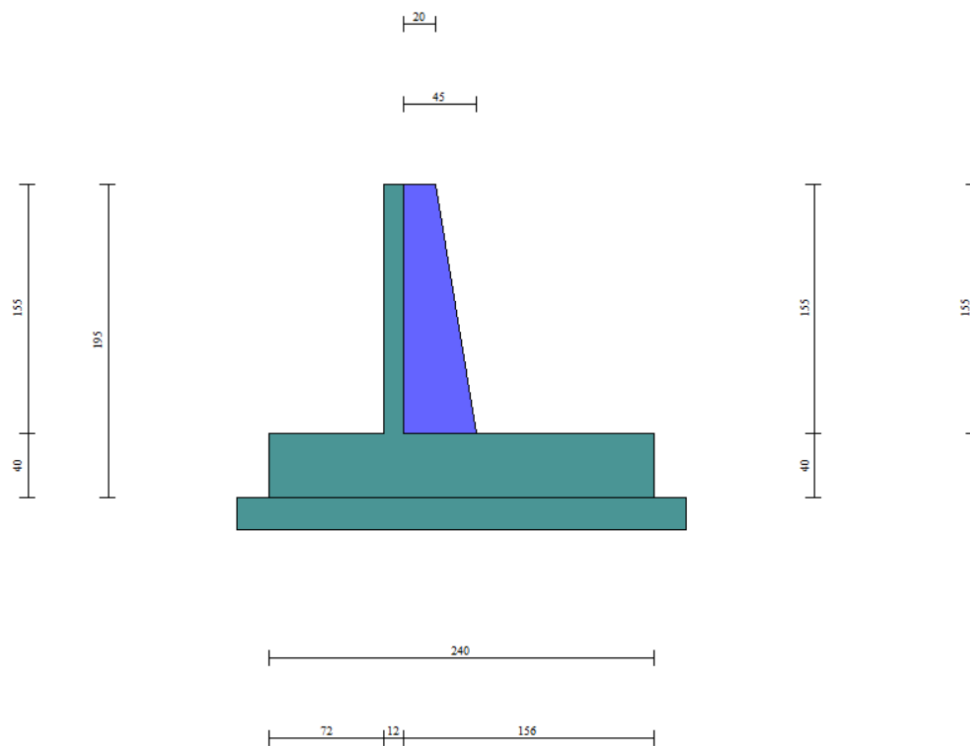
Geometria dei MURI DI SOTTOSCARPA - FONDAZIONE DIRETTA - TIPO 1
